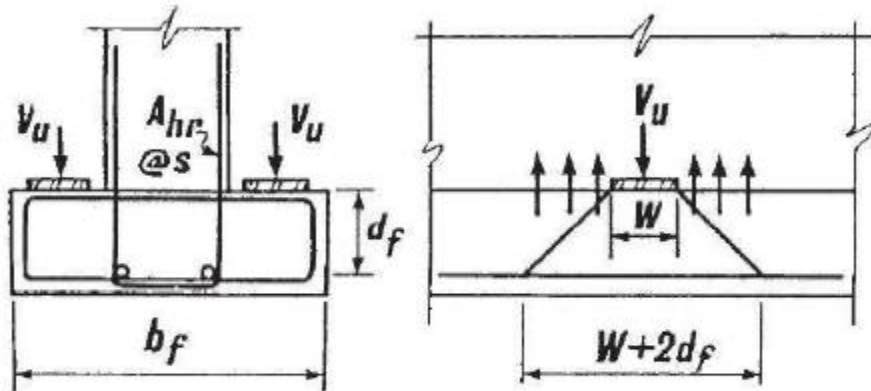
Refuerzo para Viga T invertida
